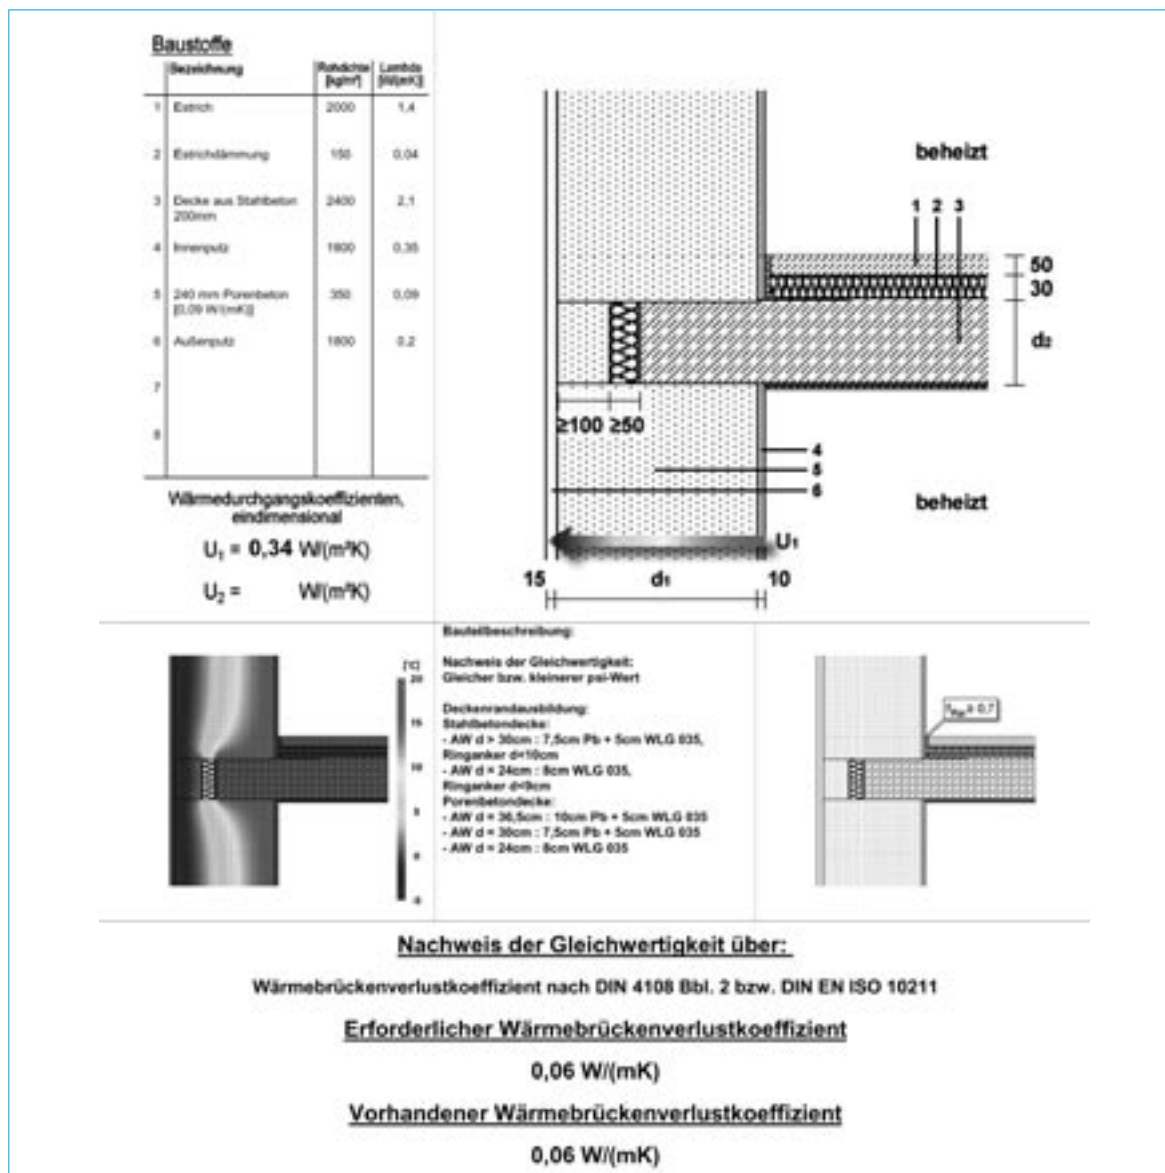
Datenblatt zum Geschossdeckenanschluss bei monolithischem Mauerwerk aus Porenbeton [18]
